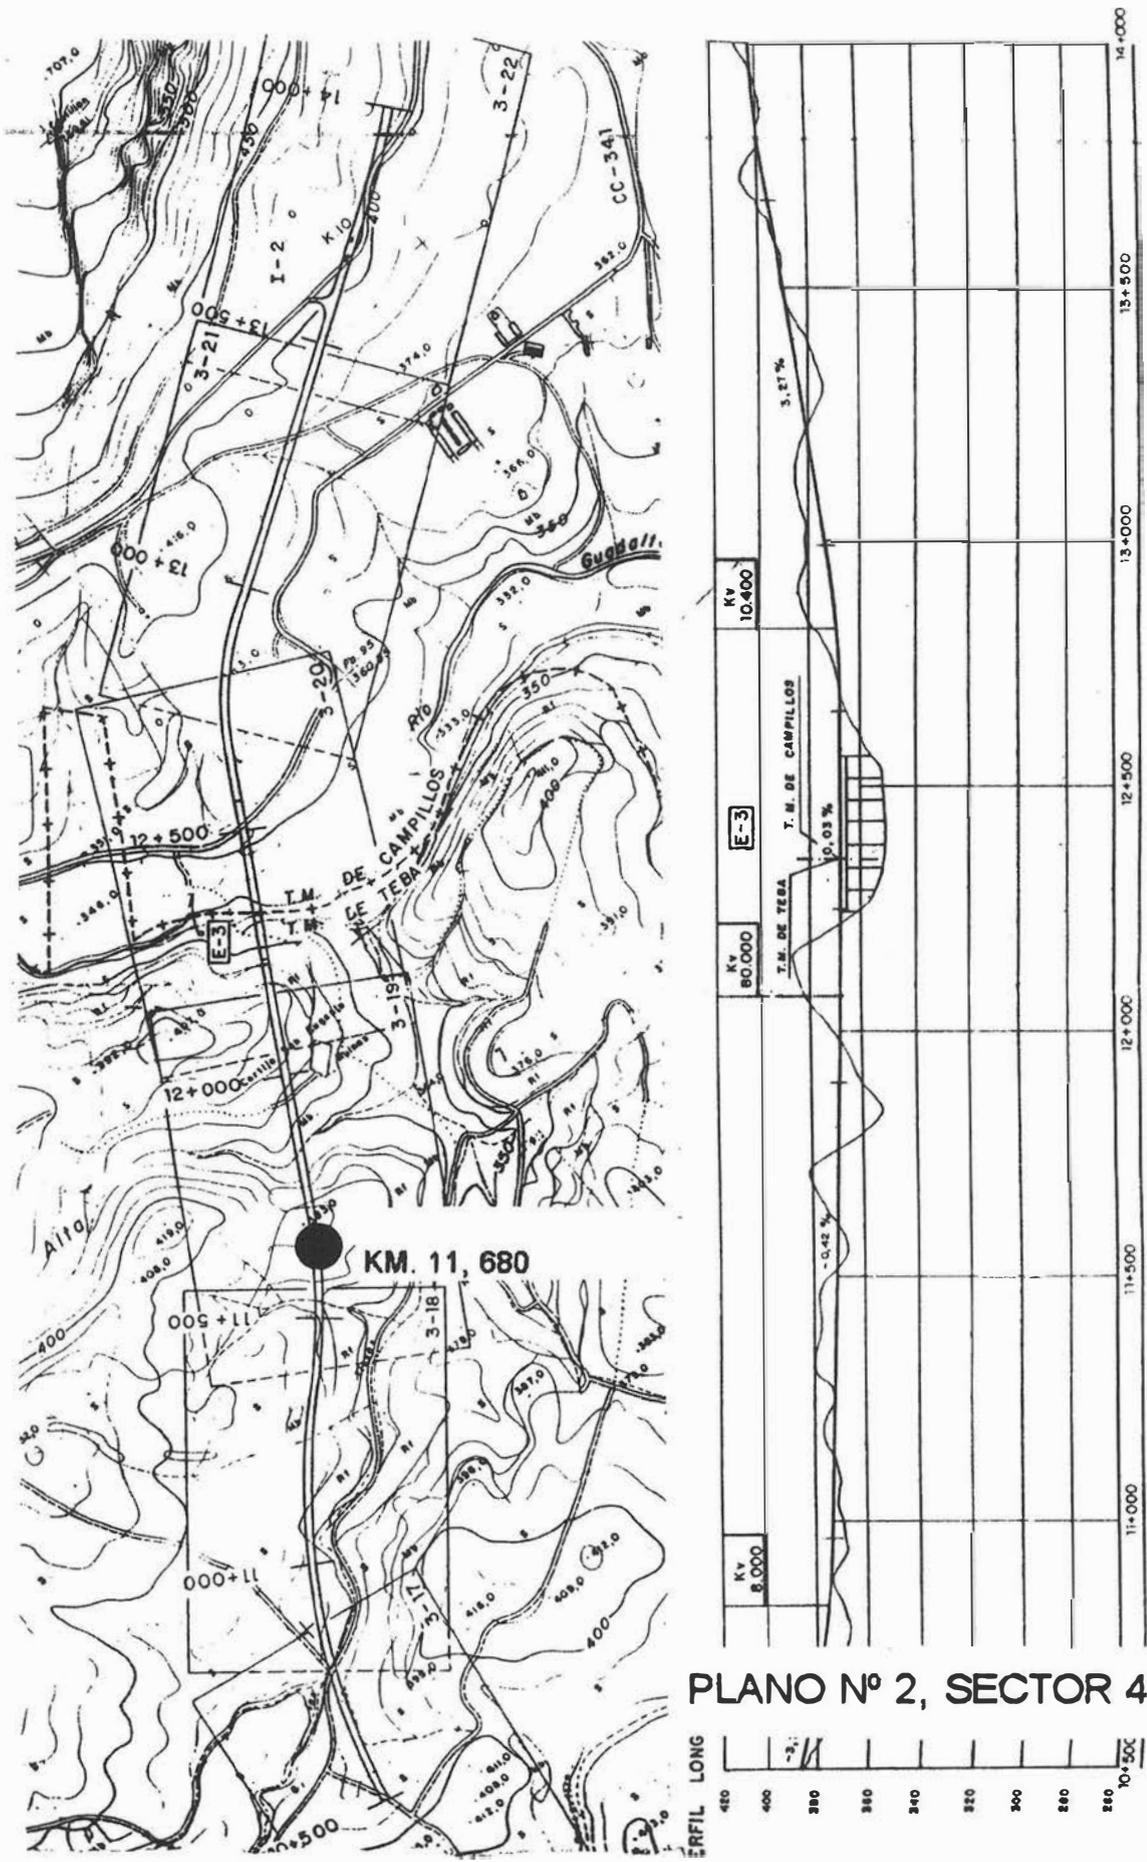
Planta y sección de la traza con ubicación del yacimiento del P.k. 11. 680.
